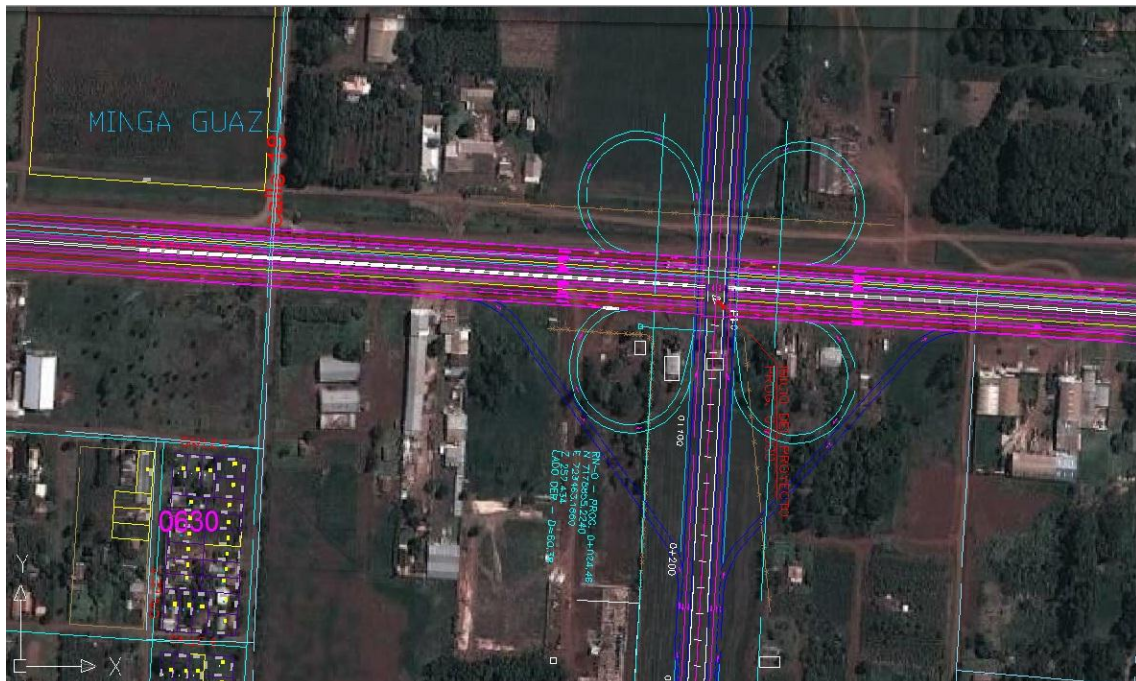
Alternativa de trazado original – Empalme en Km 17,5
